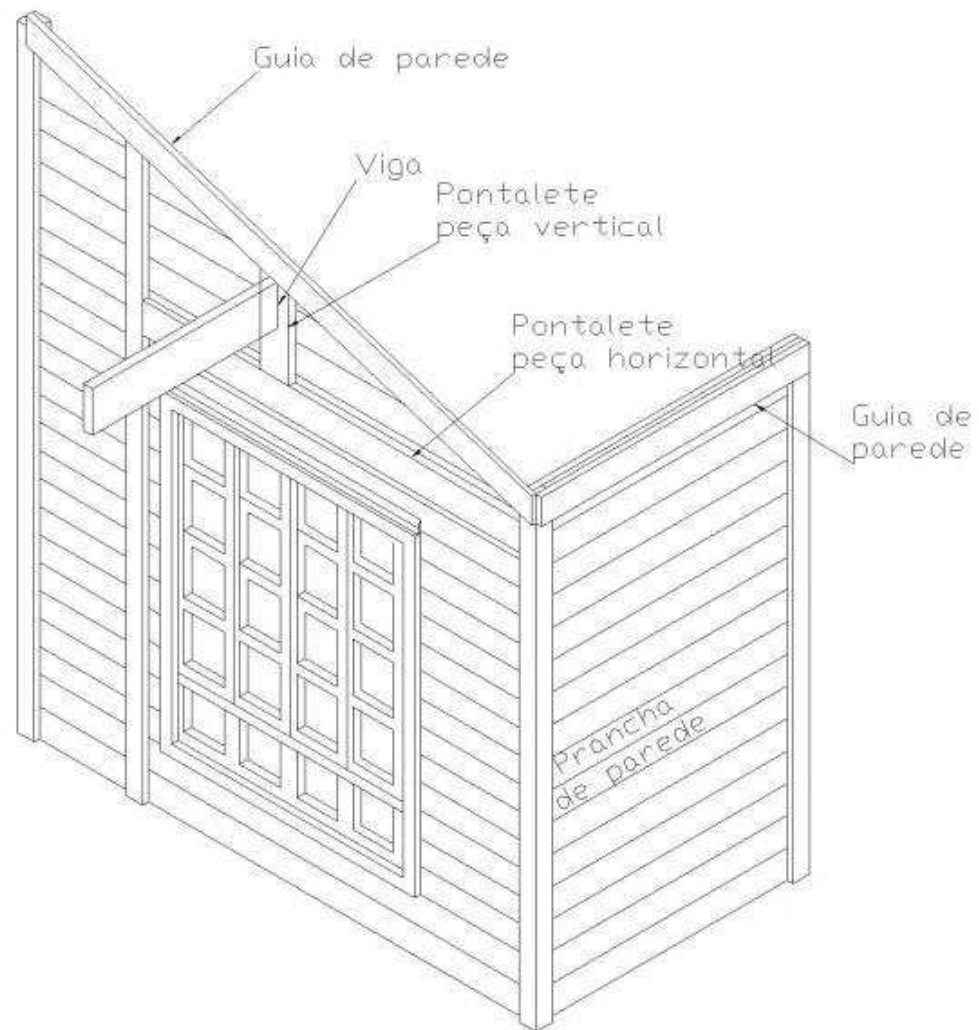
Detalhe de montagem da estrutura de cobertura viga-pilar.
